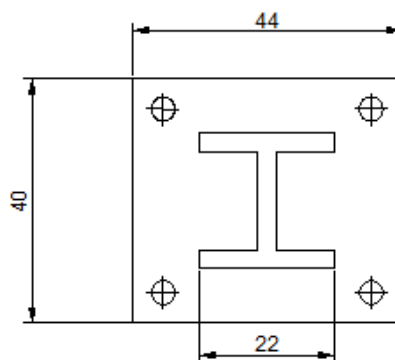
37. Dimensiones de la placa de anclaje a comprobar.
